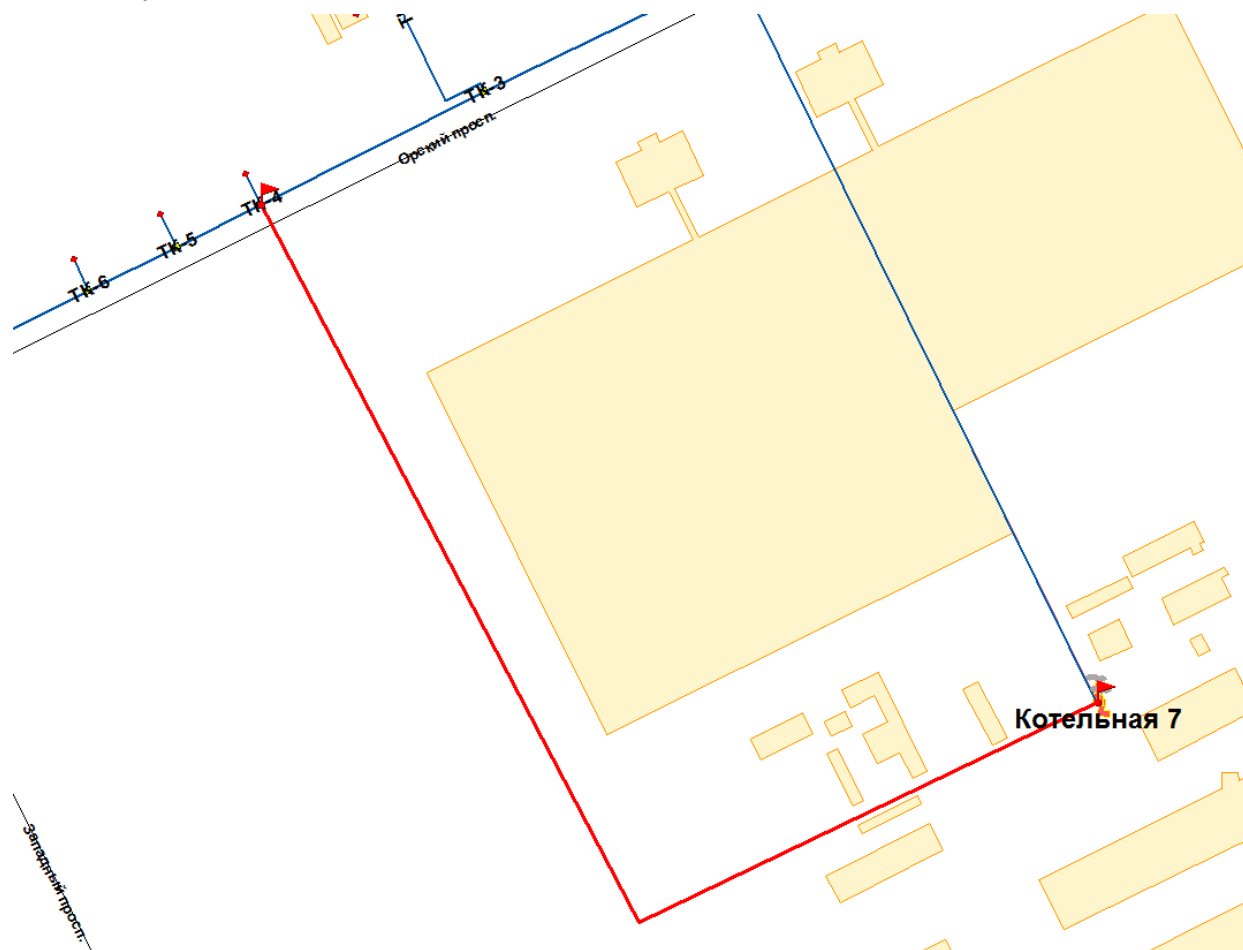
Схема прокладки трубопровода для подключения тепловой нагрузки котельной ОАО «ОКУ» к котельной № 3
